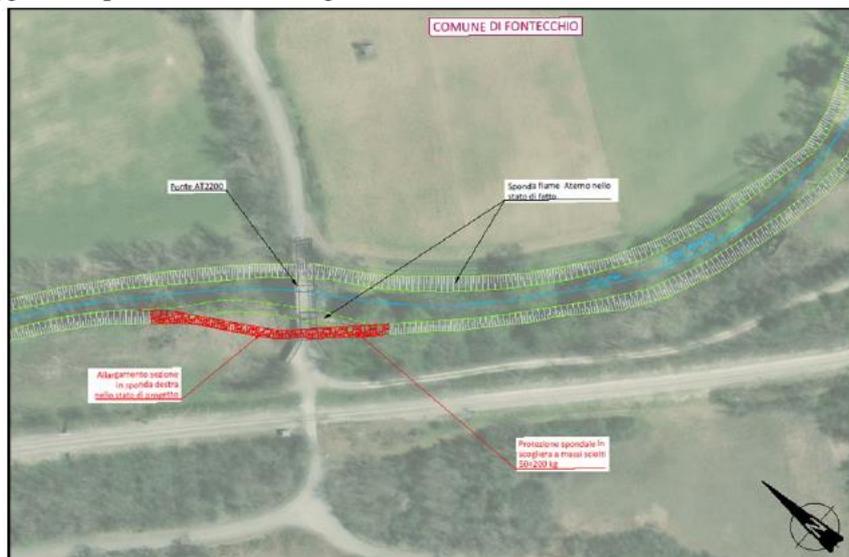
Stralcio planimetrico intervento ponte AT2200 a Fontecchio.
